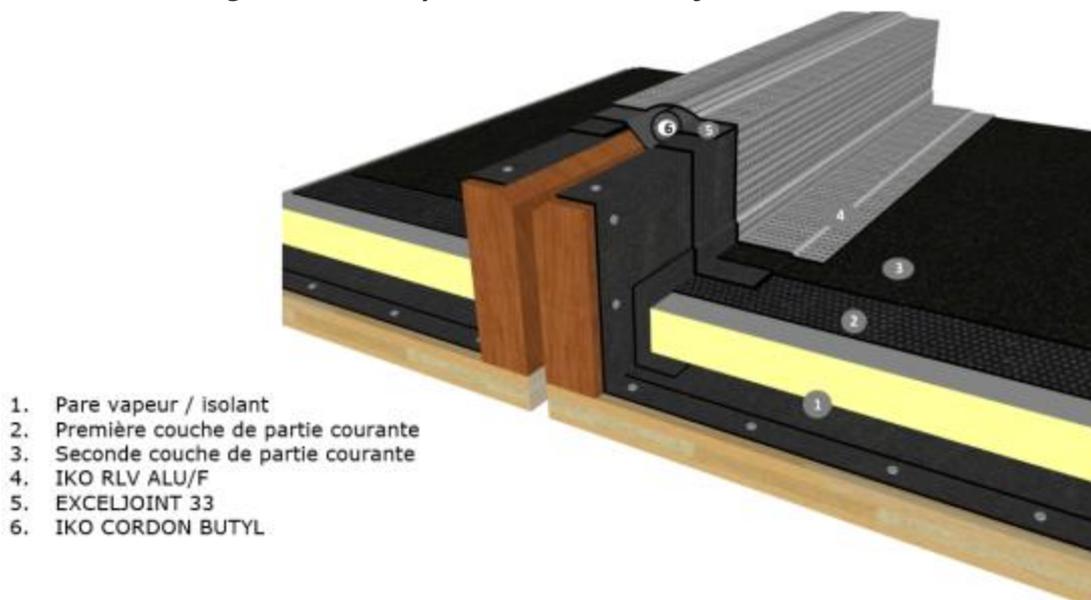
Exemple de traitement d'un joint sur panneaux à base de bois
